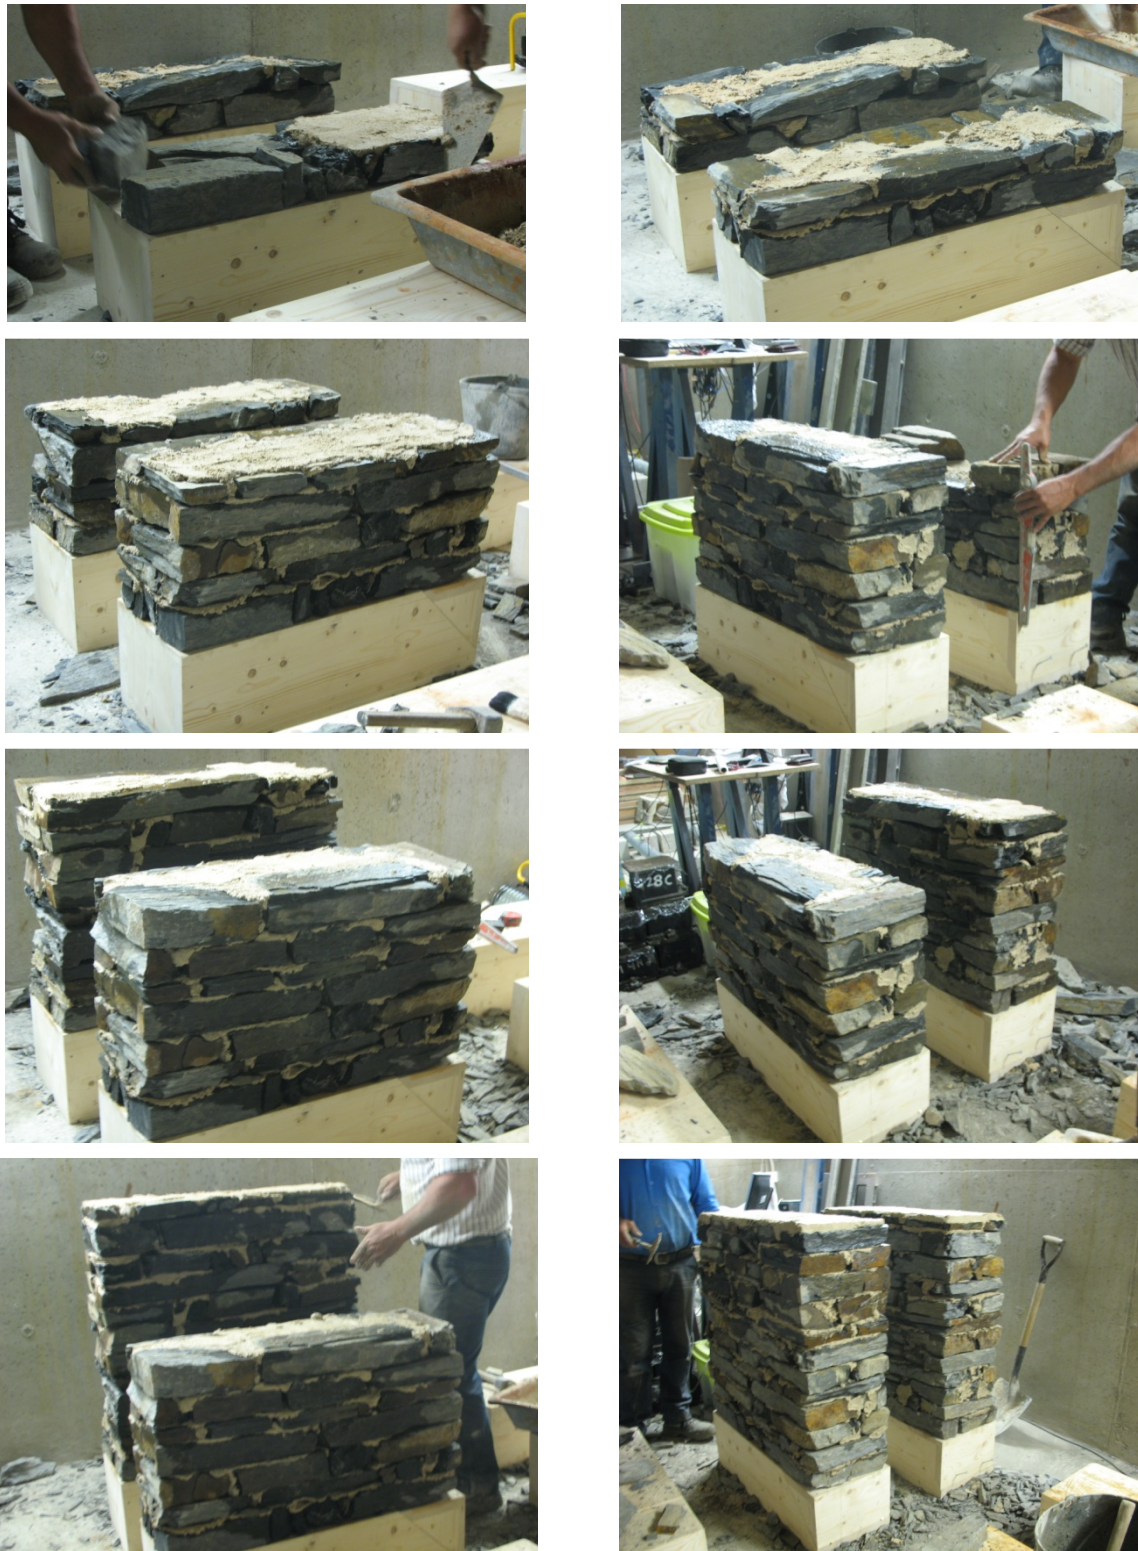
Construção das paredes de alvenaria de xisto.
